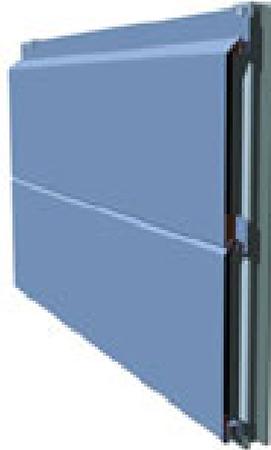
Painel metálico perfilado em aço galvanizado.
